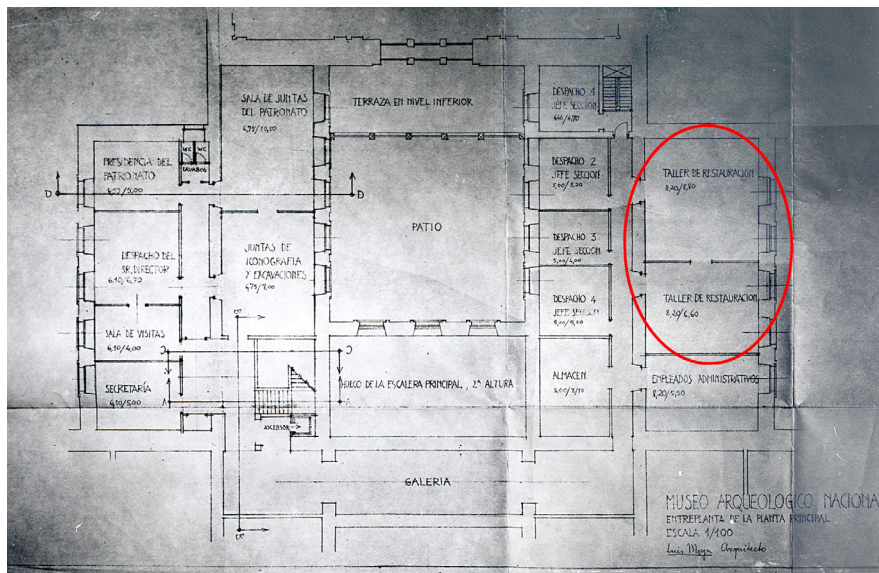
Plano de la «Entreplanta de la planta principal» del arquitecto D. Luis Moya, con los talleres de restauración previstos en el Proyecto de 1961 marcados en rojo (fot. MAN, FD00284).
